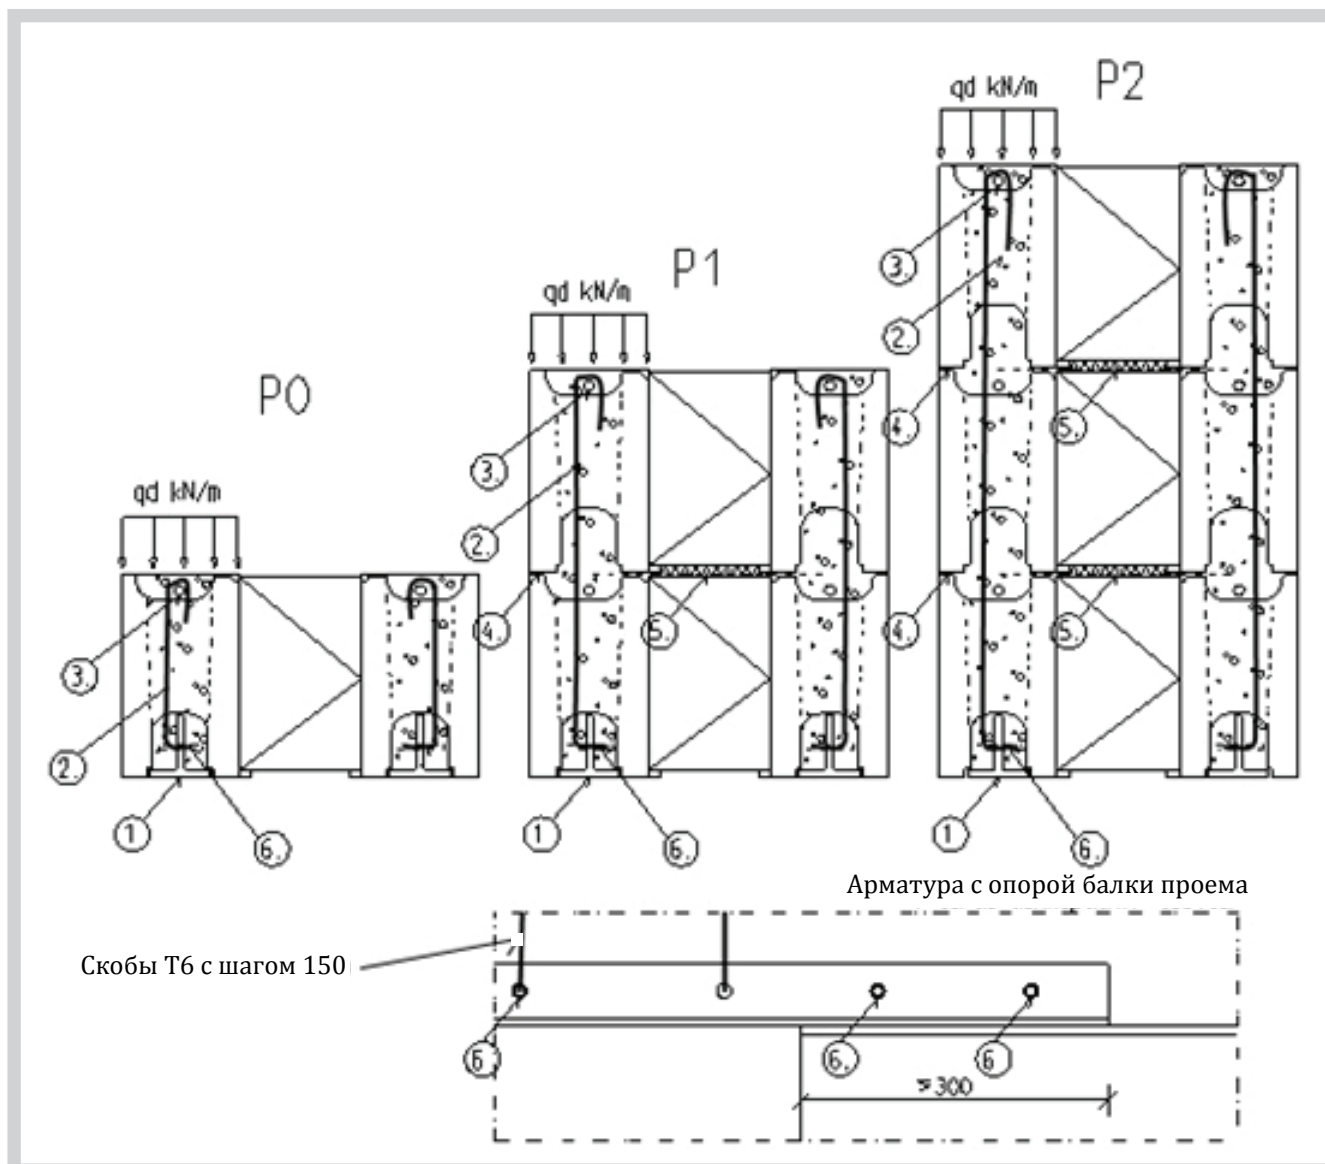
Строительство балки проема ЕКО-350 и ЕКО-380 с помощью балочных блоков.
